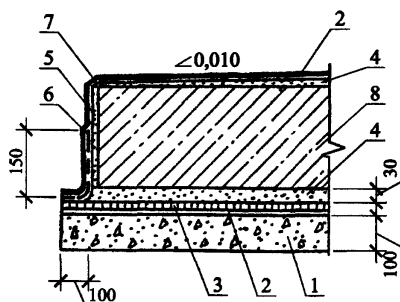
Узел 14. Асфальтовая и окрасочная гидроизоляция
